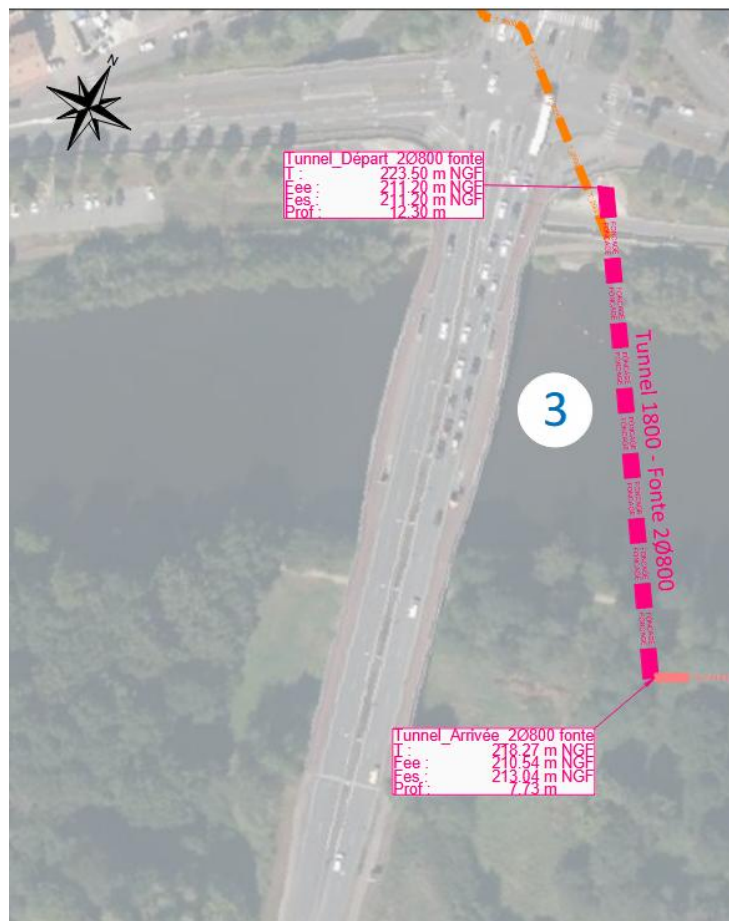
Plan de la traversée de Vienne - Deux canalisations Fonte DN 800 mm
